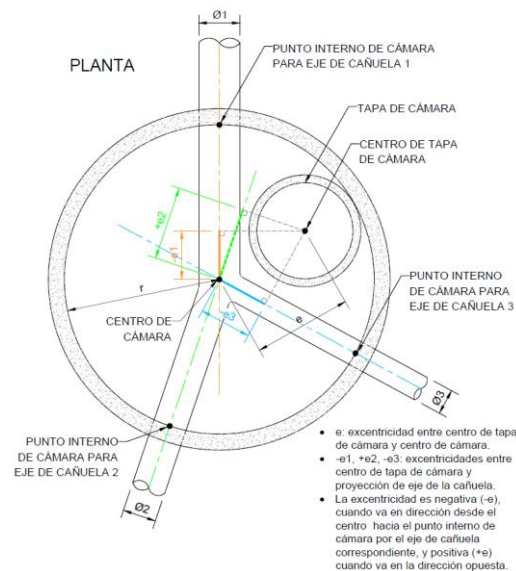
Detalle en planta para el levantamiento de medidas para el cálculo de longitud de tuberías
